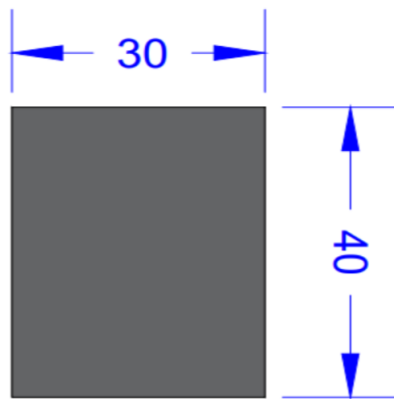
Dimensions des poutres principales et secondaires.
